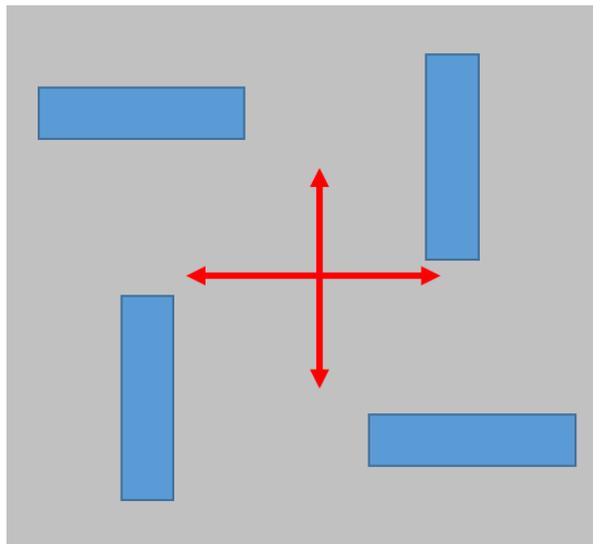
Um 90° versetzte Kantholzstapel (Grundriss)
